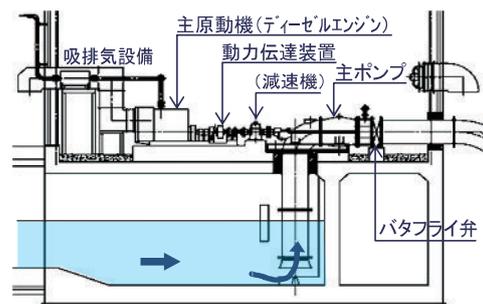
ポンプ設備断面図(例) 横軸ポンプ
